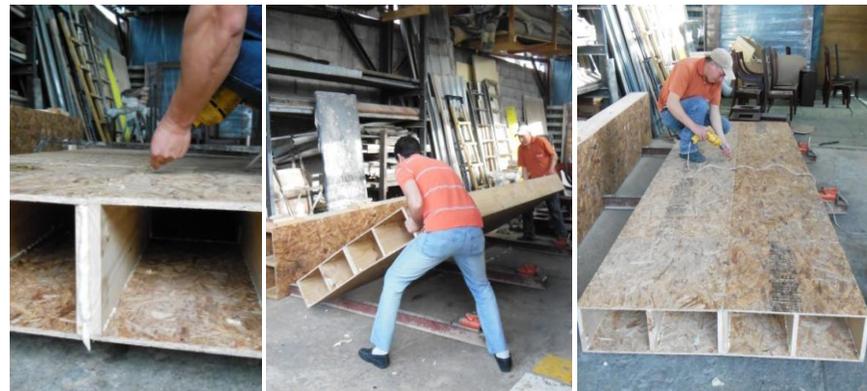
Unión superior e inferior con tornillos cincados alternados (derecha e izquierda)
